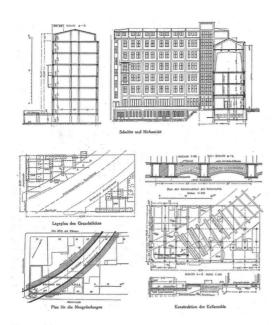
Edificio de Max Taut. Estructura, cimentación y detalles constructivos (AHCOAM GM/CP088/C1-39)
